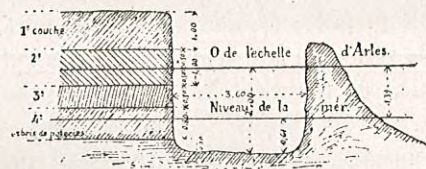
COUPE DES FOUILLES DE FONDATION DE LA GARE MARITIME.
